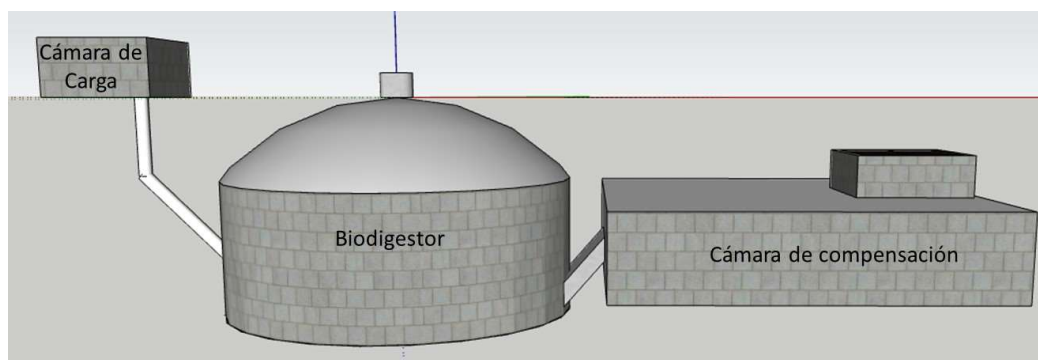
Planta de biogás – Cámaras y biodigestor
